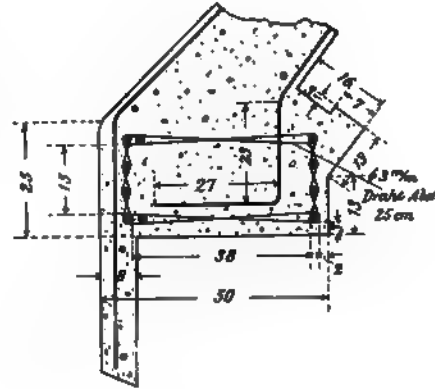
Auflagerung der Dachhaut auf der Stirnwand (Querschnitt).
